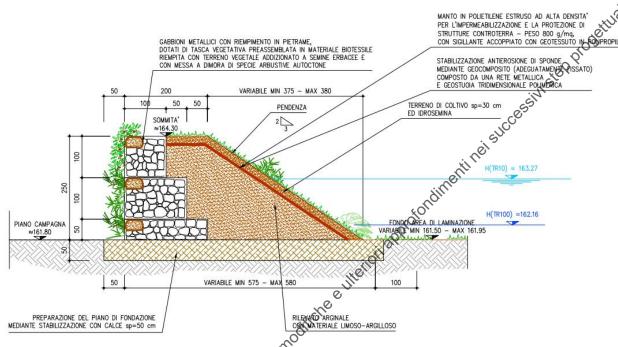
sezione tipo 3, Area di laminazione A. Estratto da Tav. 10
